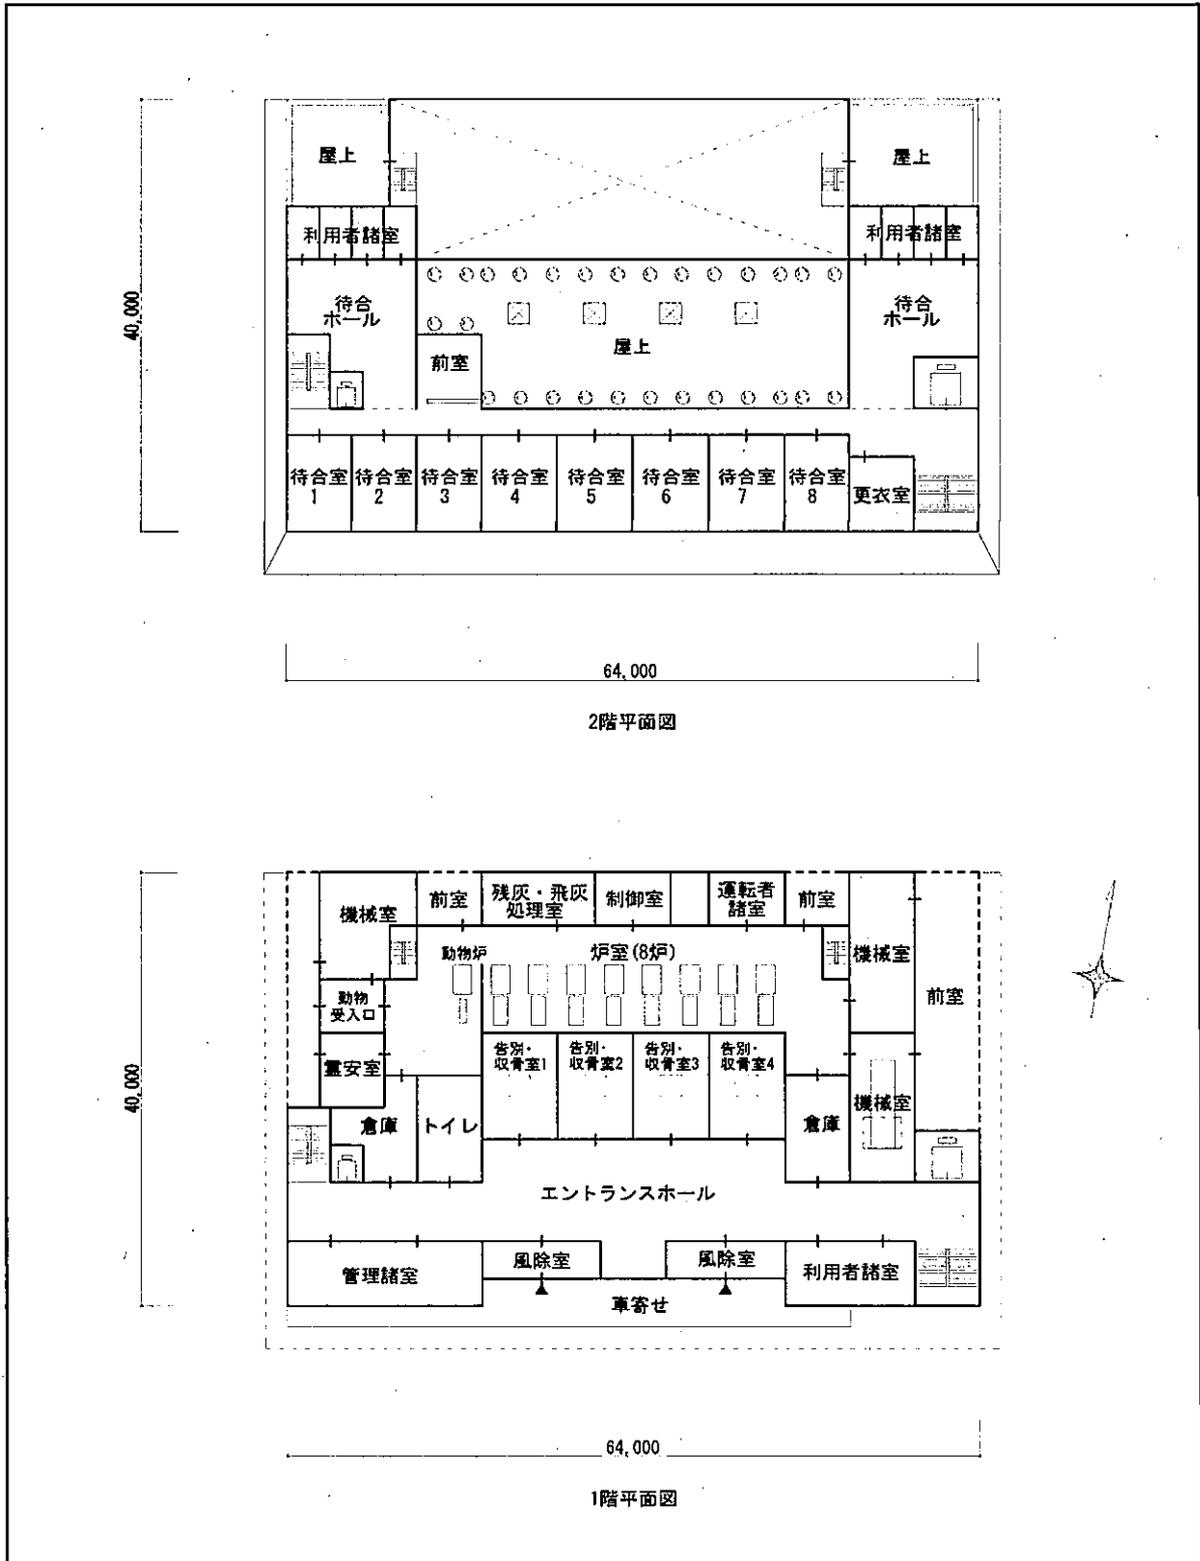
2 草津市単独整備(2.0件/基・日) モデルプラン平面図
